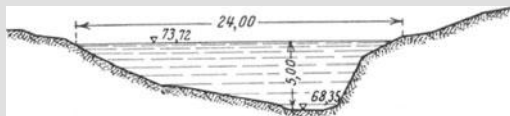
Leine oberhalb Elze. Strecke stark gekrümmt. Maßstab 1 : 550 und 1 : 600.
